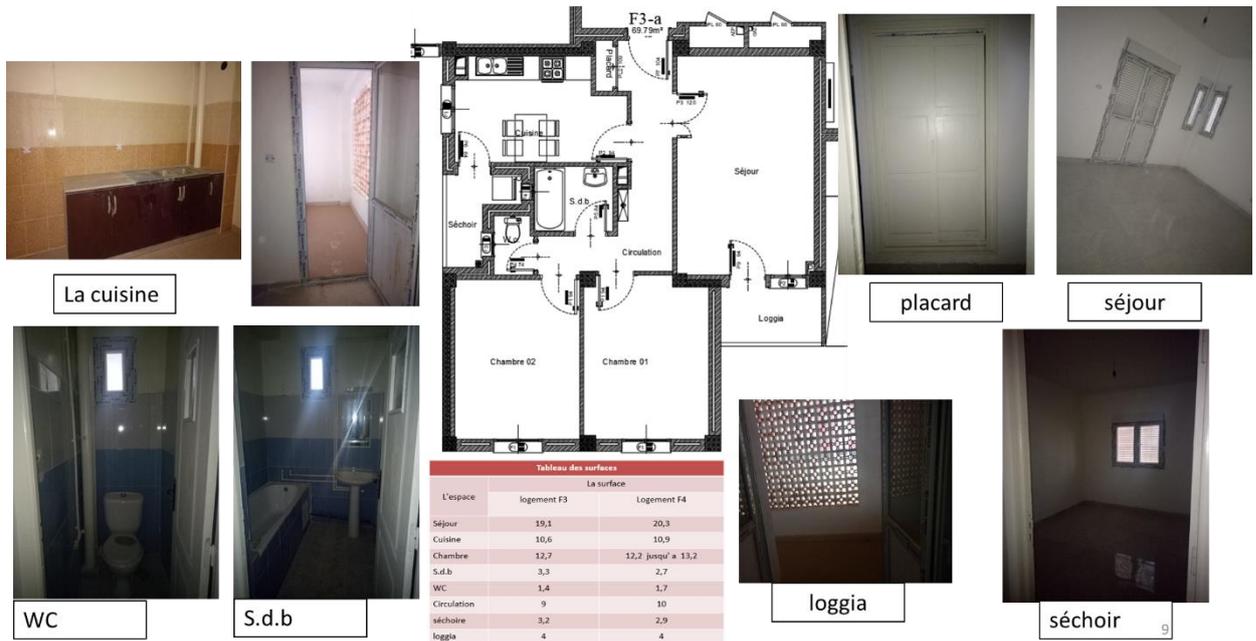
modèle de plan de logement F3 traité par l'auteur
